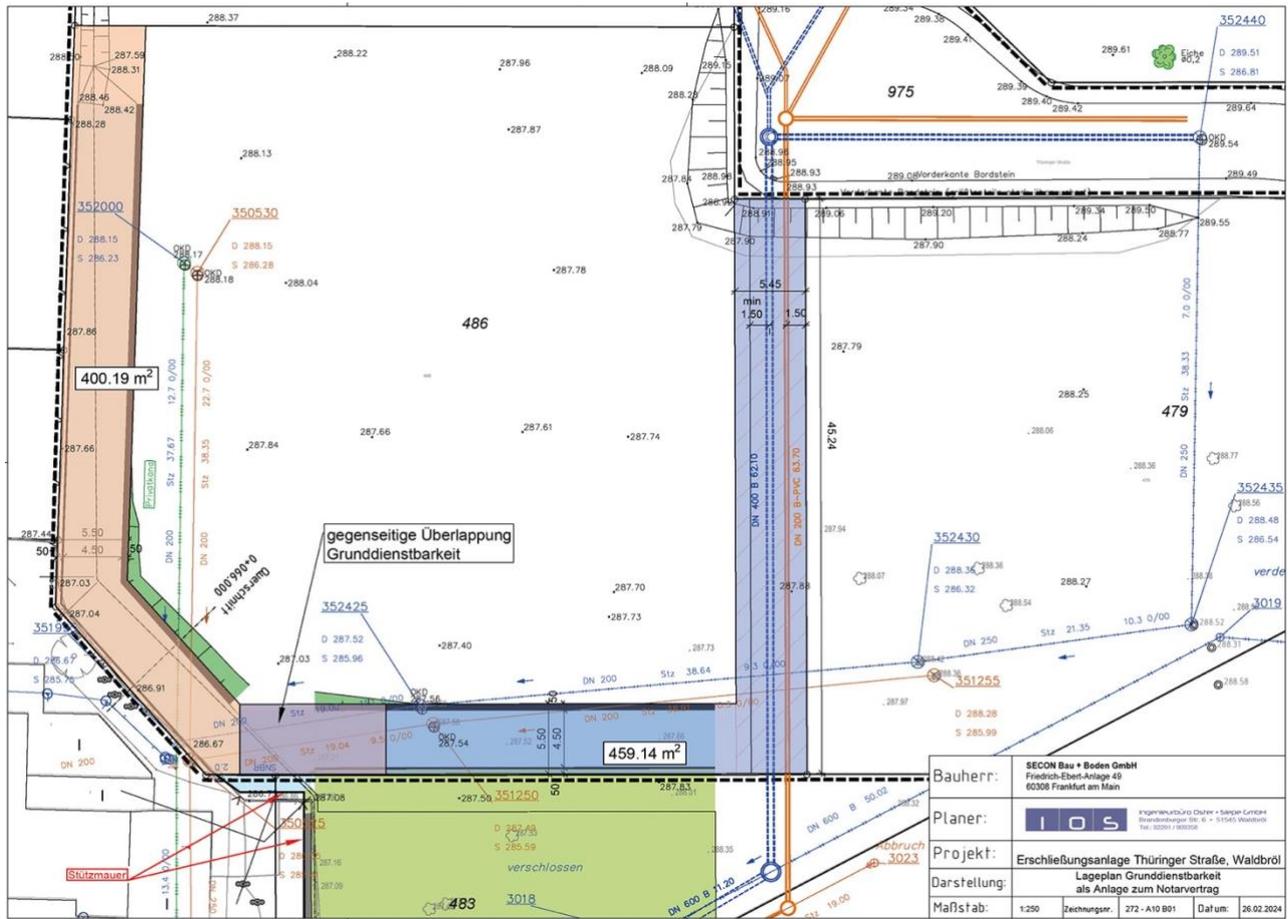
Lageplan der Grunddienstbarkeiten (Quelle: IOS Ingenieurbüro Oster + Sieper GmbH, Waldbröl, Stand: 2024)
